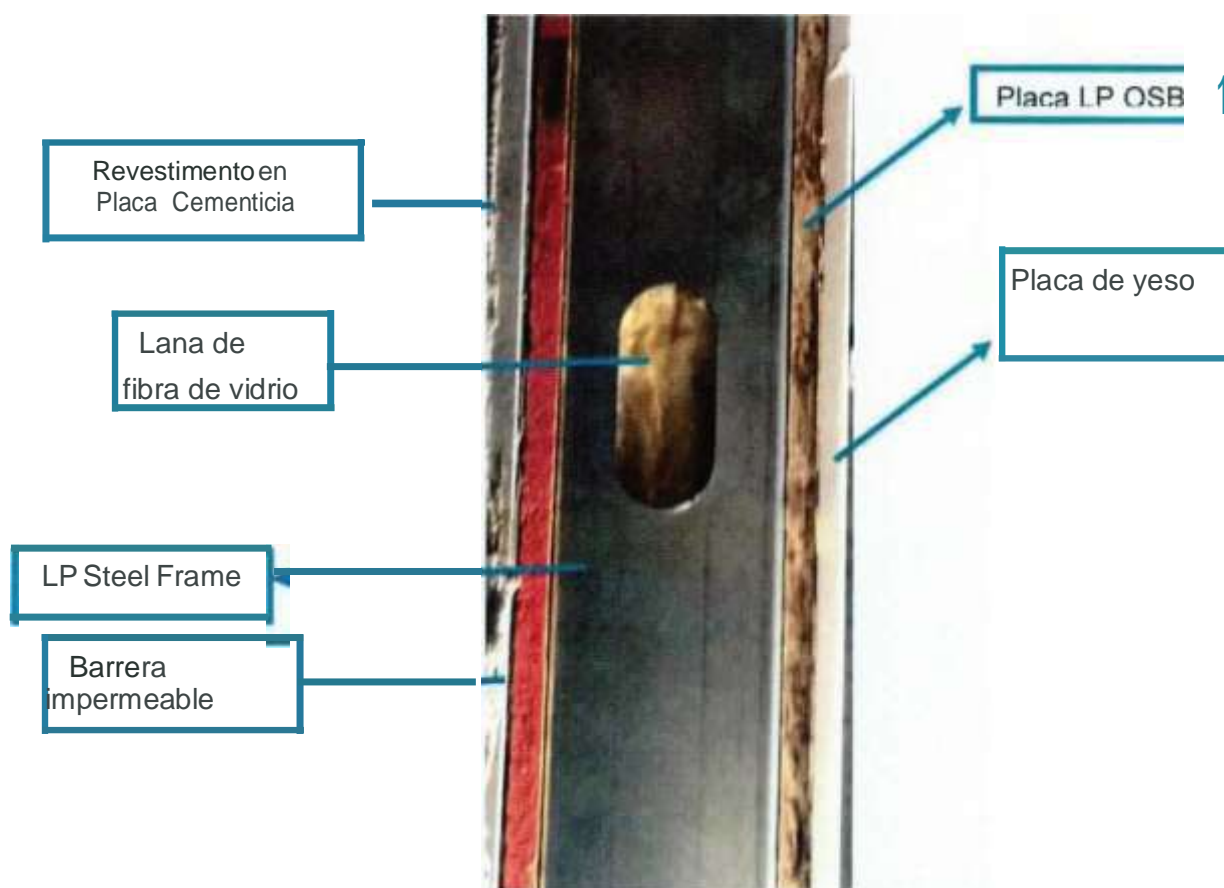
Detalle de las capas del sistema de fachada ensamblado
